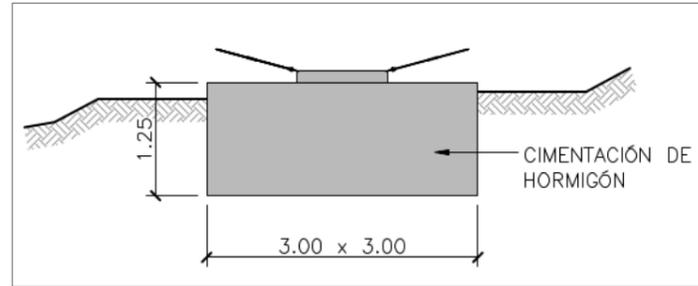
Cimentación central para atirantamiento de estructura en "looping".
